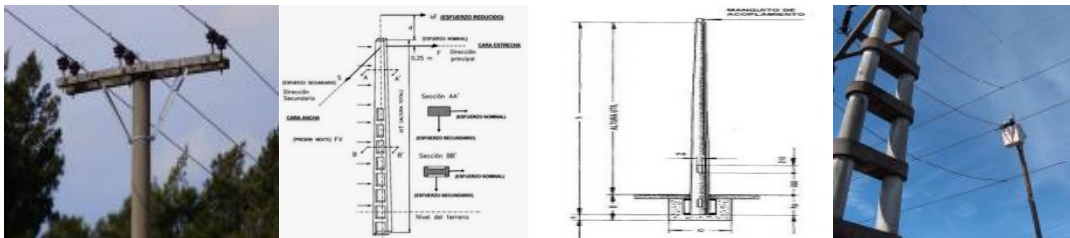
Postes de hormigón: armado, vibrado, centrifugado y pretensado [2].
